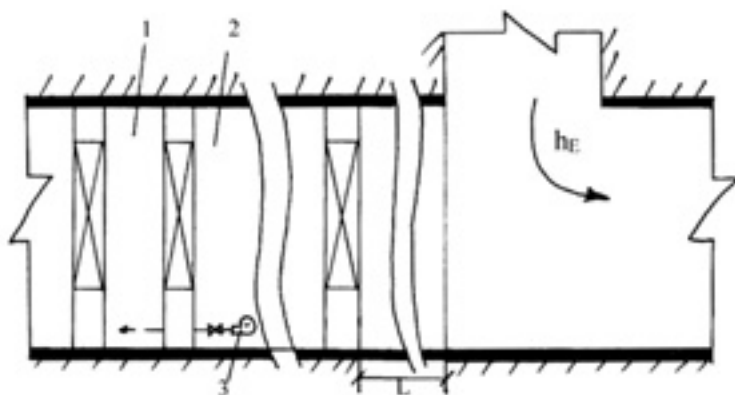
Схема подпорной вентиляции в убежище для противохимической защиты без использования фильтров-поглотителей
